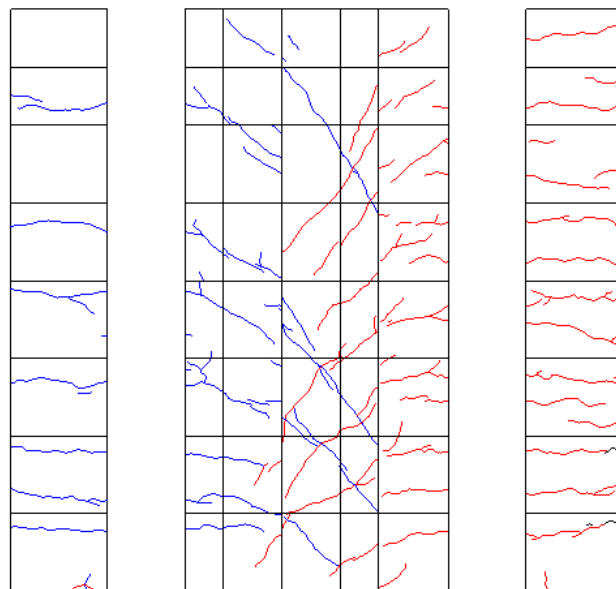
R=-1/133 ひび割れ図
